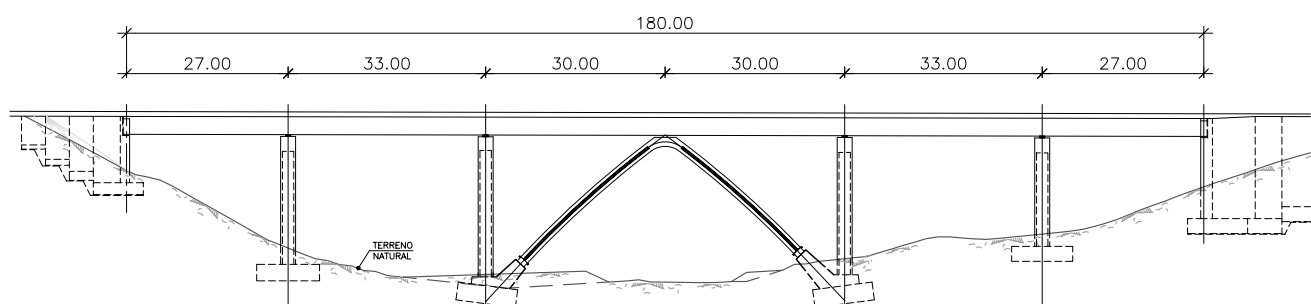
Puente con conexión a punto fijo intermedio. Alzado
